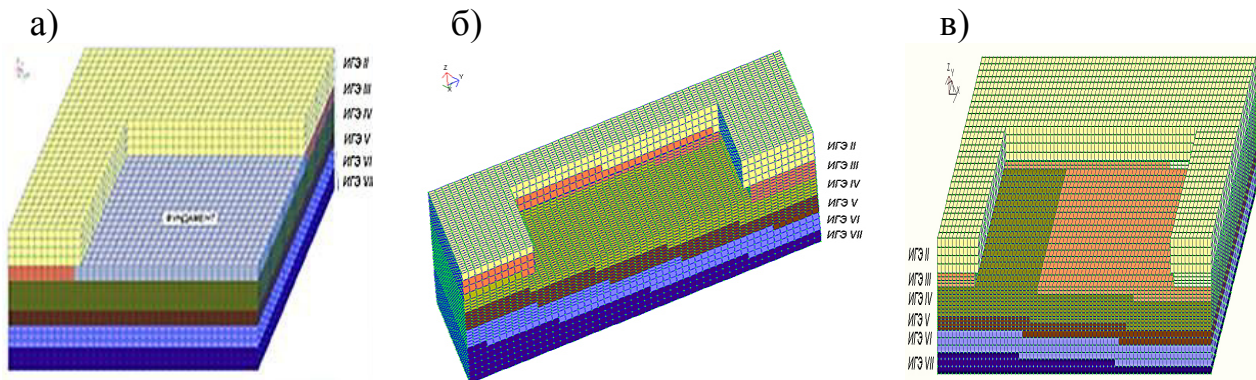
Варіанти ґрунтової основи: горизонтальне залягання шарів (а); нахил шарів  $4^{\circ}$  поперек будівлі (б); нахил шарів  $1,5^{\circ}$  уздовж будівлі (в)
